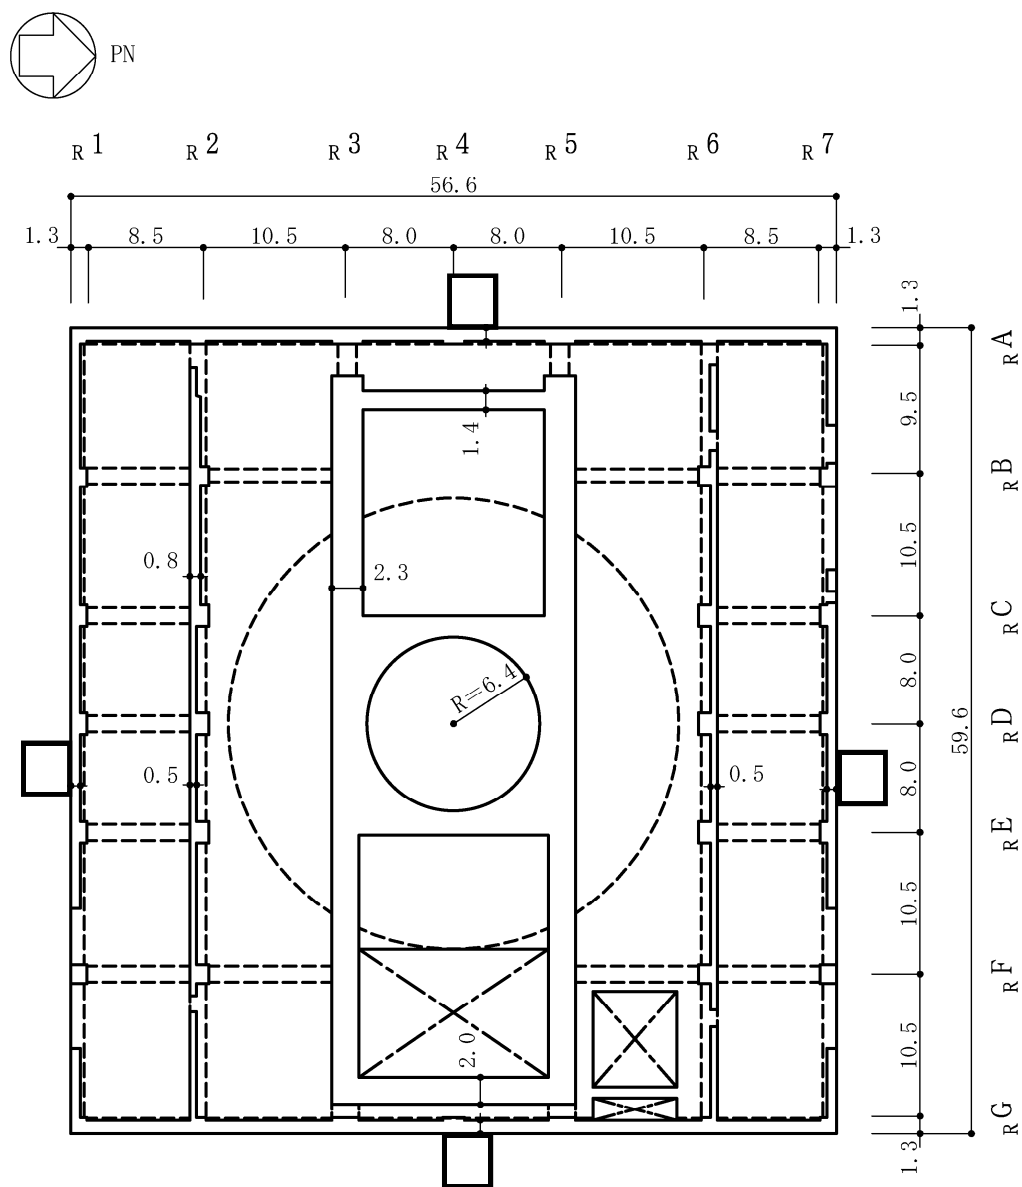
原子炉建屋の概略平面図 (3F, T.M.S.L. 23.5m) (6/9) (単位 : m)
